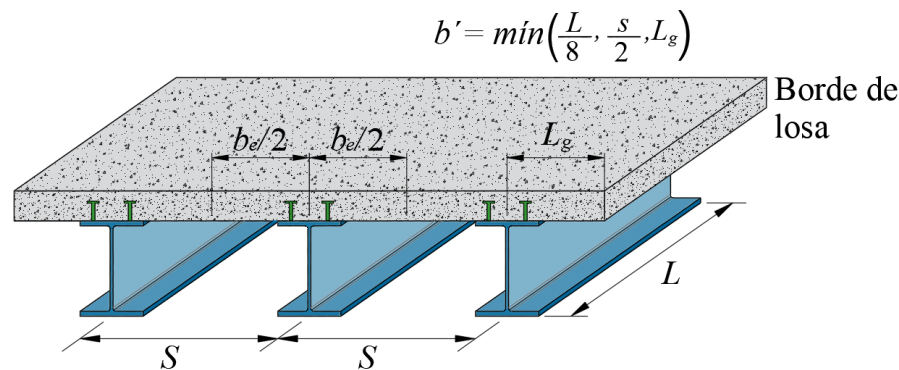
Ancho efectivo de vigas compuestas
